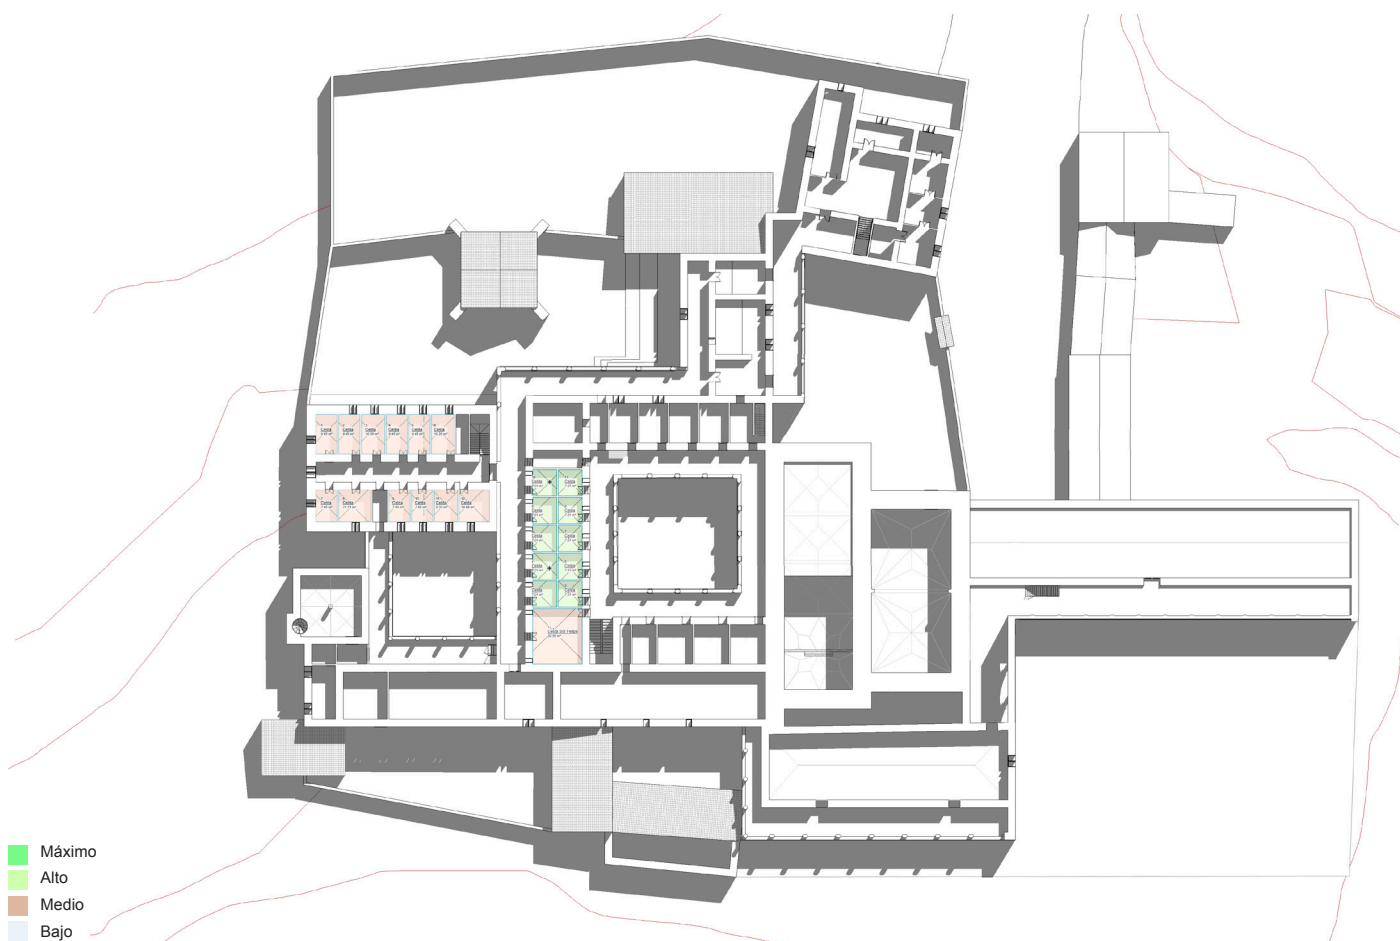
| Visualización de Nivel de Conservación | Planimetría +5.00m
